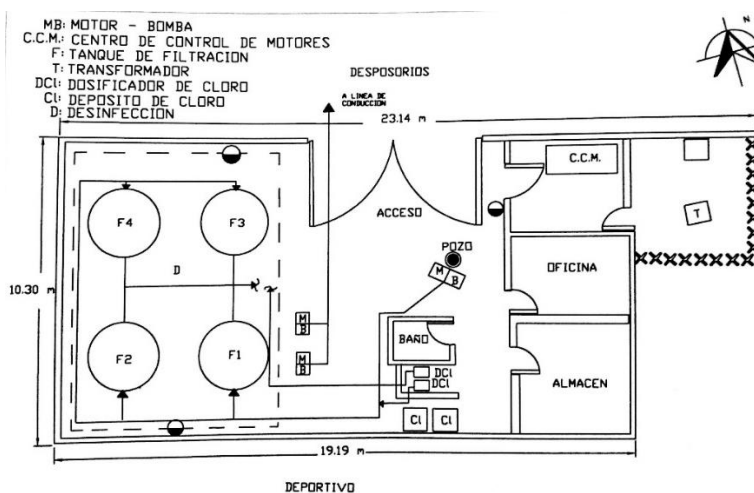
Vista en planta de la PP Santa Catarina 11
